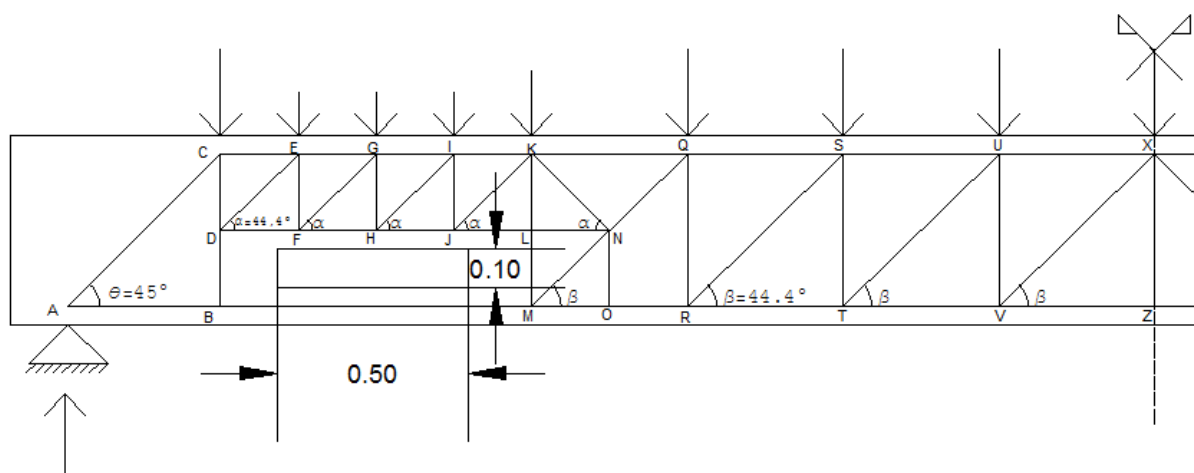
Pormenor do modelo de escoras e tirantes com abertura adotado para a Viga I.
